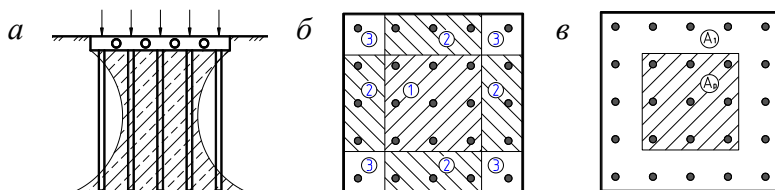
Расчётные схемы отпора грунта в основании (а) и схемы разбиения на расчетные зоны свайного поля (б) и плиты-ростверка (в):
